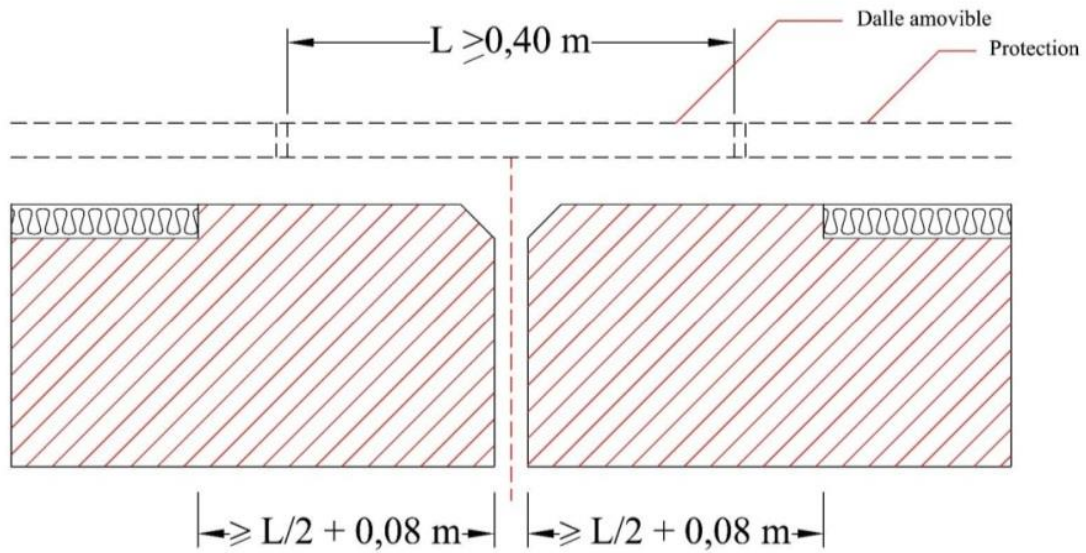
Encuvement pour revêtement à base d'asphalte en toiture accessible piéton sous protection dure sur mortier
